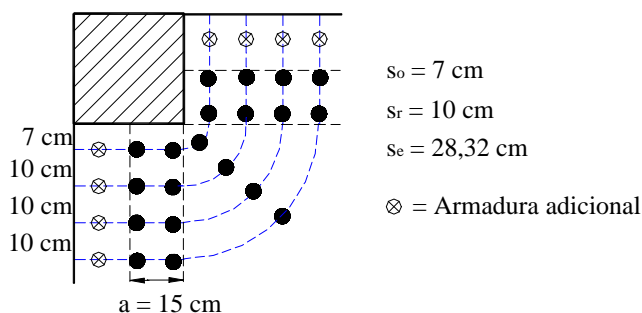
Arranjo dos conectores tipo pino para o pilar P1
